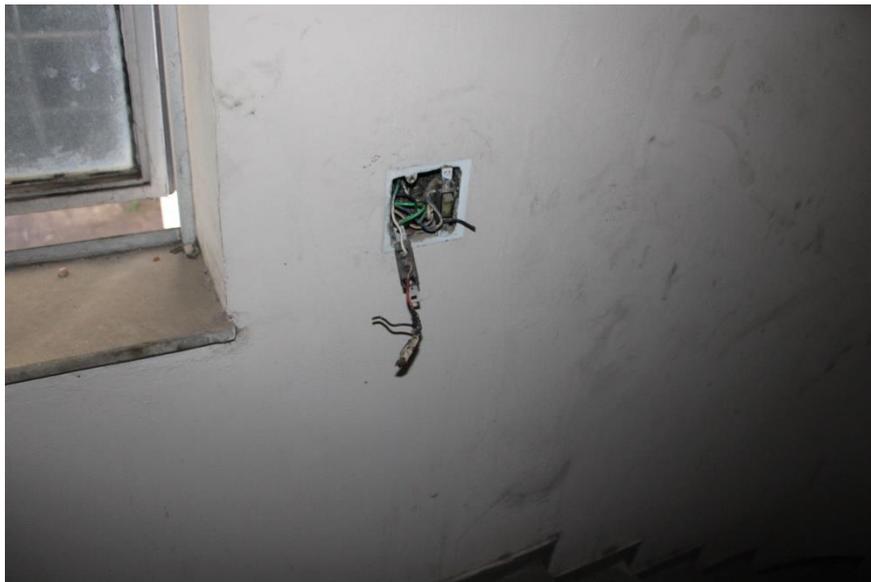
Fios expostos na caixa de escada 5º pavimento
